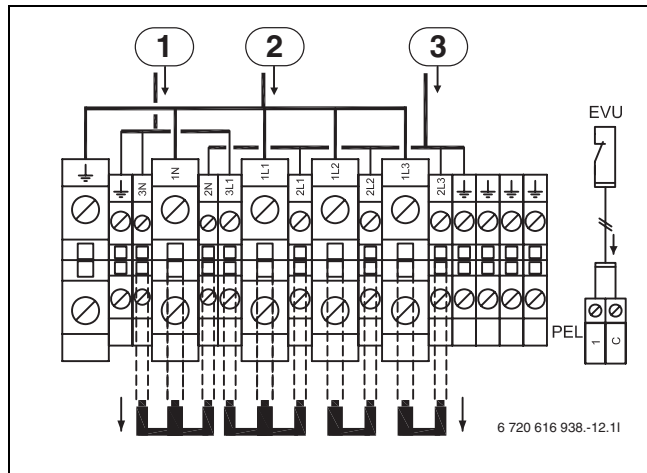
Anschlüsse Alternative B (T 430-1 - T 600-1)
